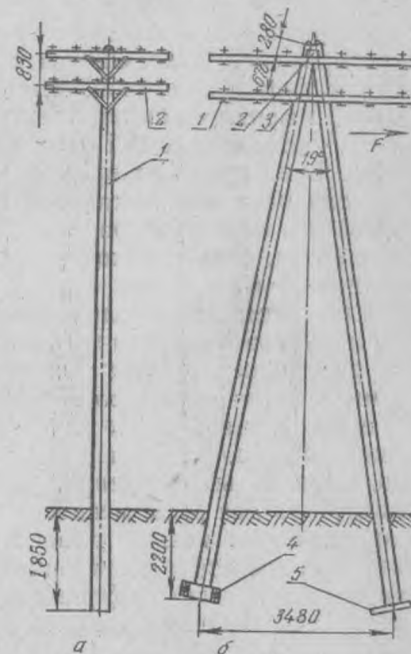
Железобетонные опоры ВЛ напряжением до 1000 В: а — промежуточная, б — угловая
